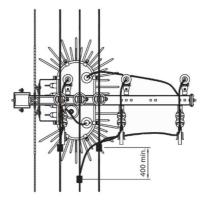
Estrutura CE2 TR (2º nível) - Poste de concreto de seção DT ou de madeira
